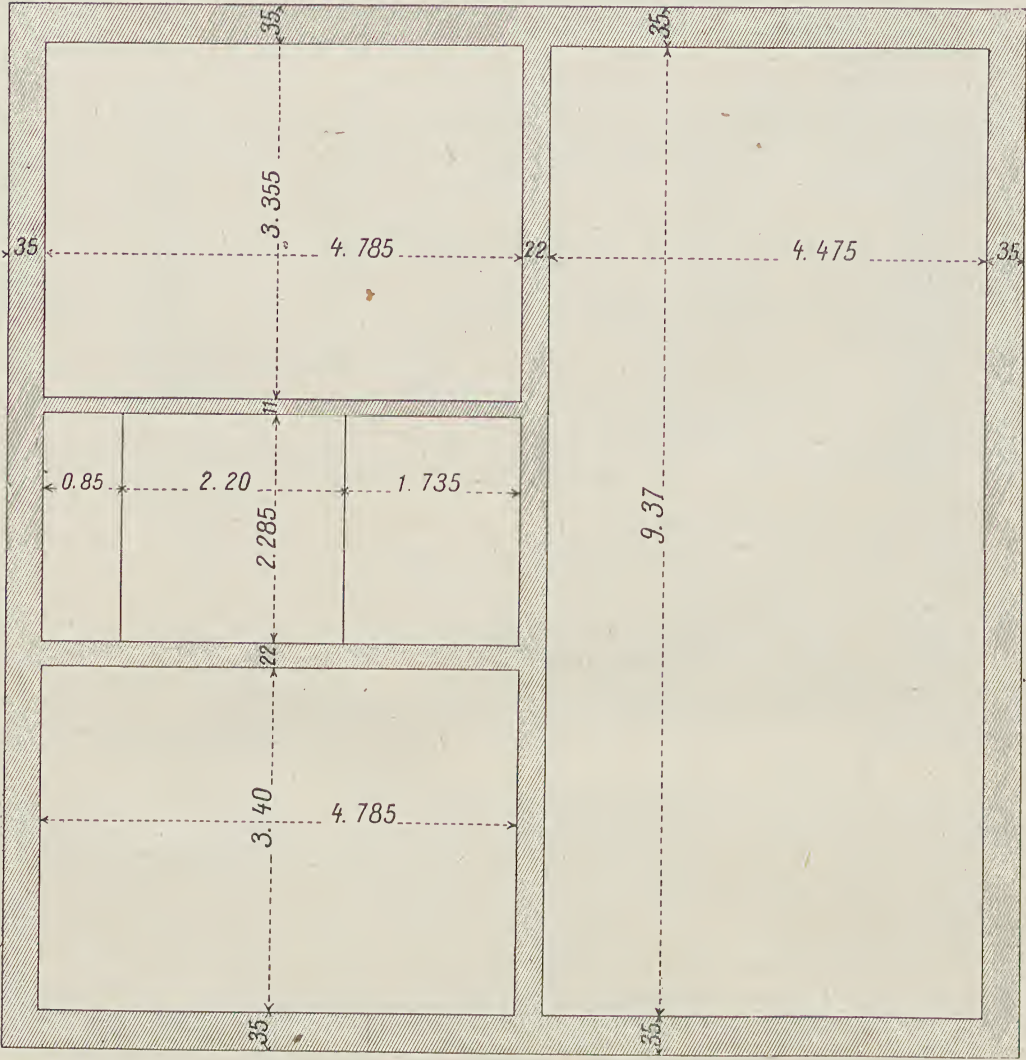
Plan du hourdis du plancher haut au 1^{er} étage.
